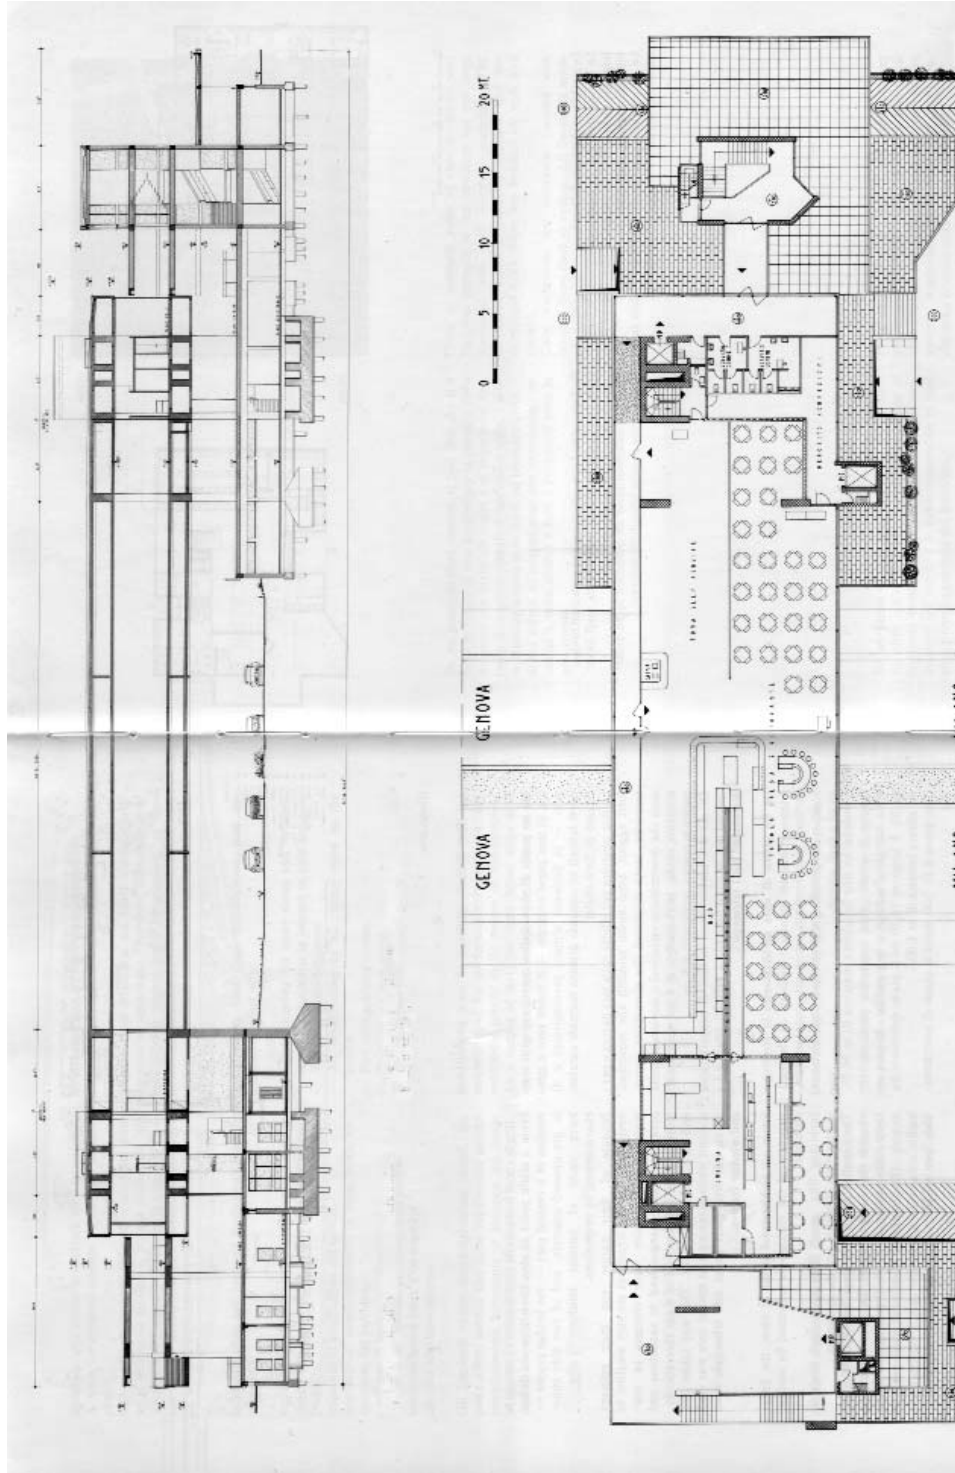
Sezione longitudinale dell'edificio lungo circa 100 metri. In basso la pianta del piano ristorante
